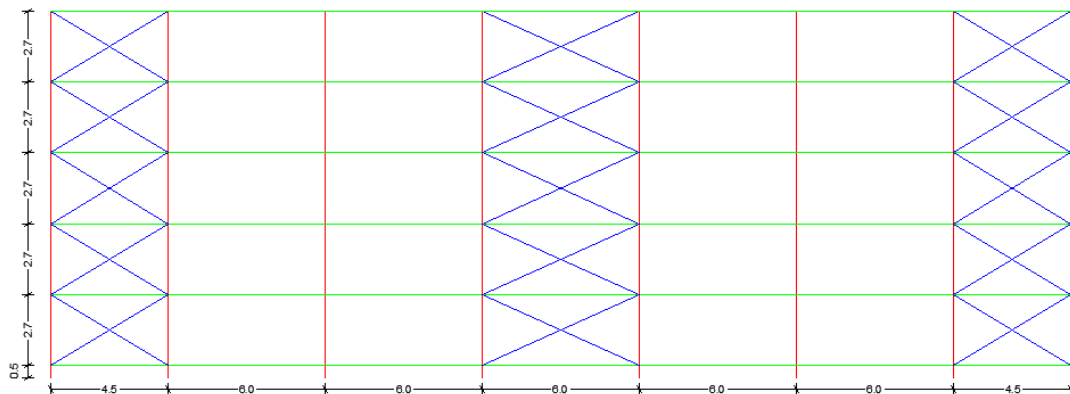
Alçado estrutural da fachada frontal e traseira
